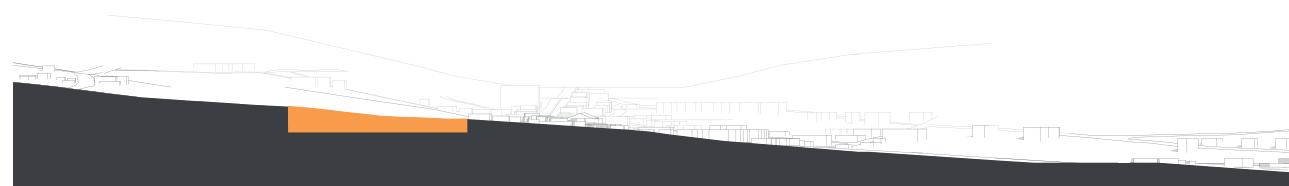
Corte longitudinal del cantón San Pedro de Pelileo
